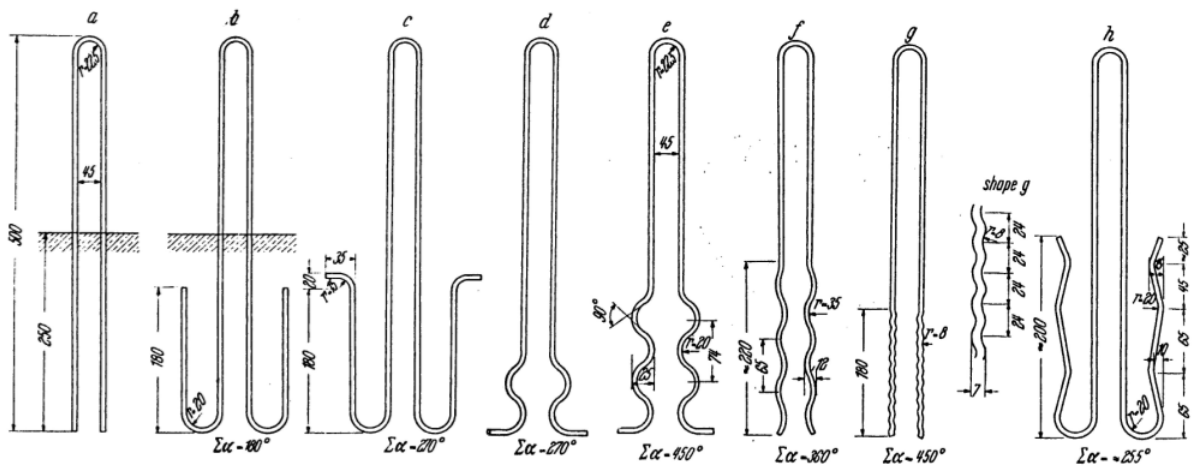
Modelos de ancoragens utilizados em arames da armadura do concreto protendido, para ensaios de aderência em tração. (LEONHARDT, 1964 p. 72)
